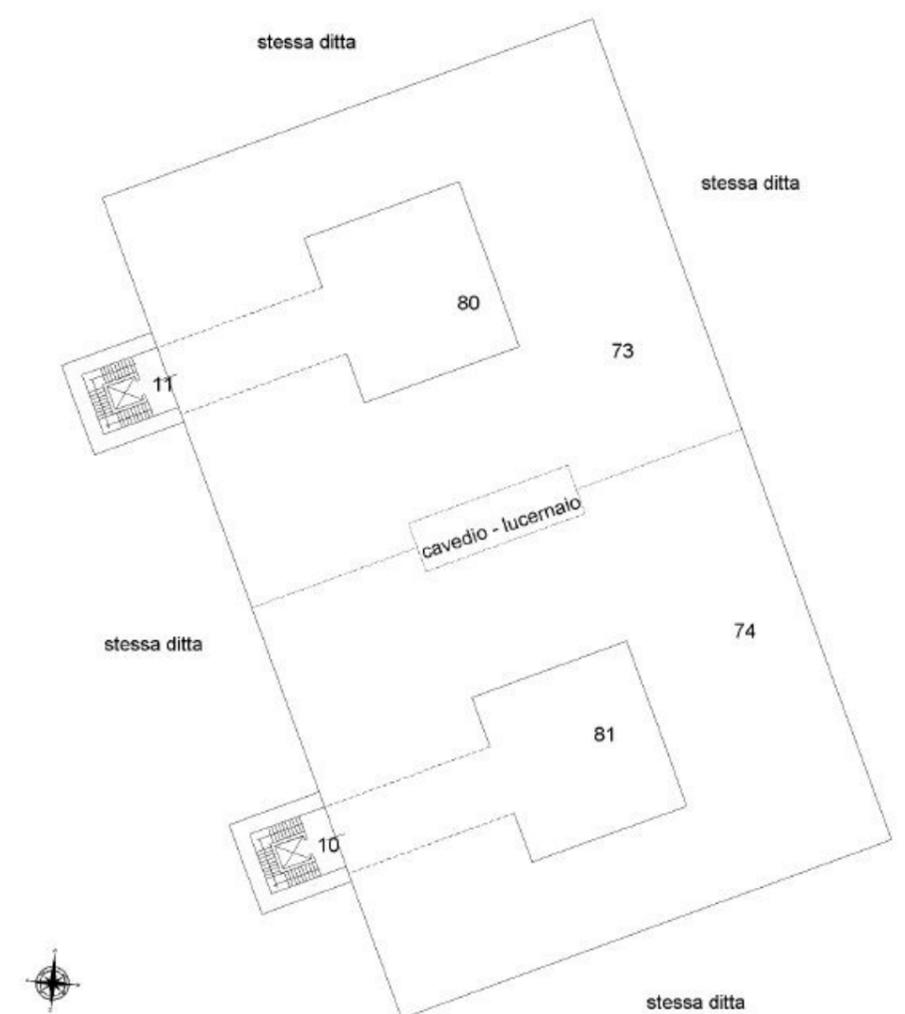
Stralcio elaborato planimetrico - Piano terzo (copertura)
